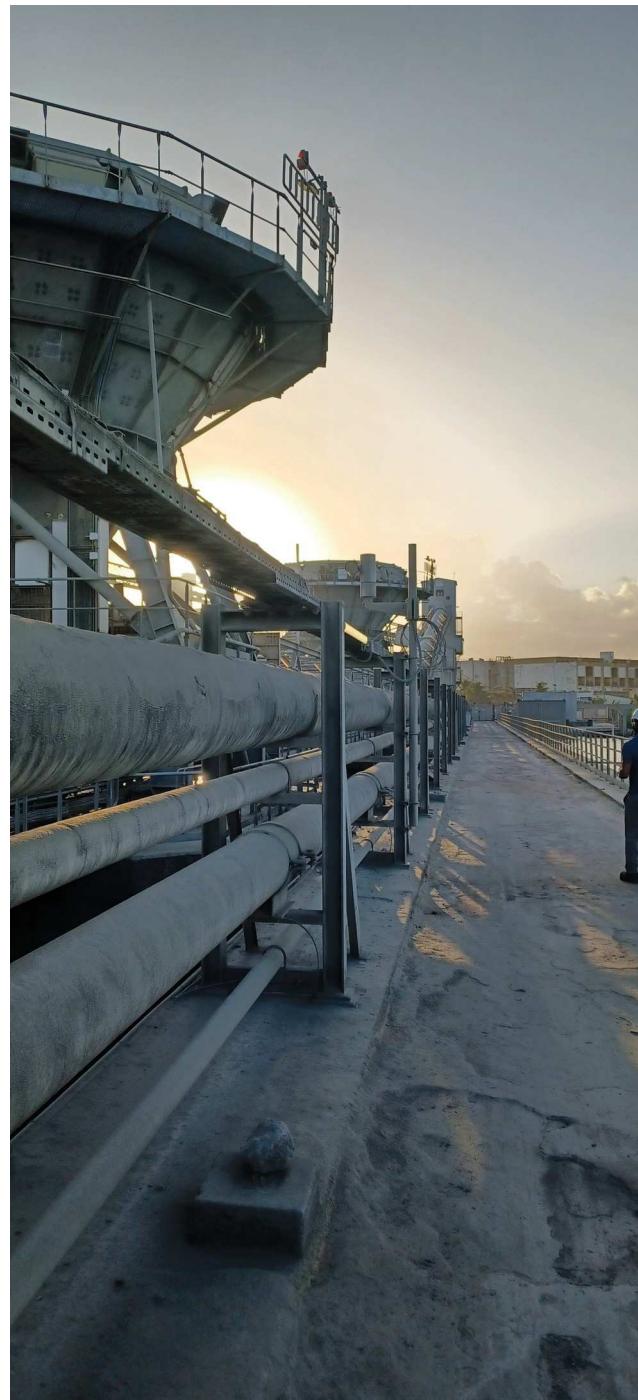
Empoussièvement des pipes des équipements et du sol au niveau du quai n°9
